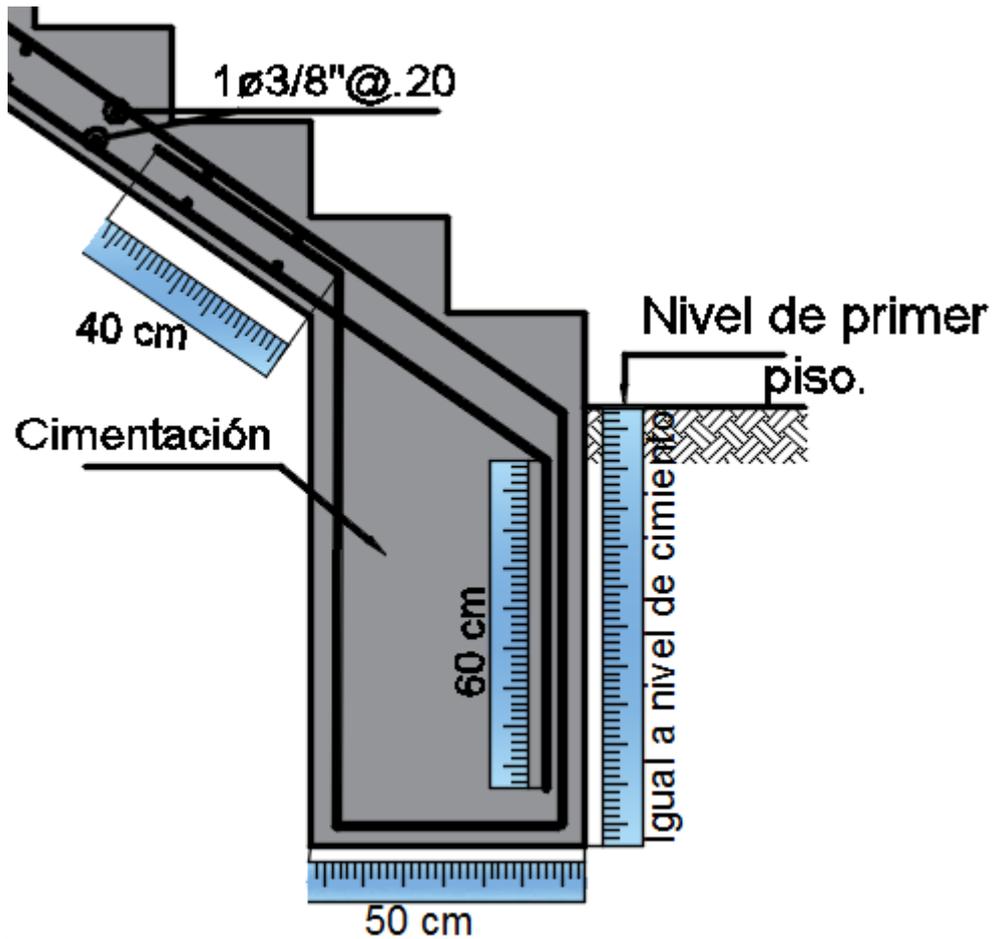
Detalle de acero en la parte inferior de tramo de escalera.
